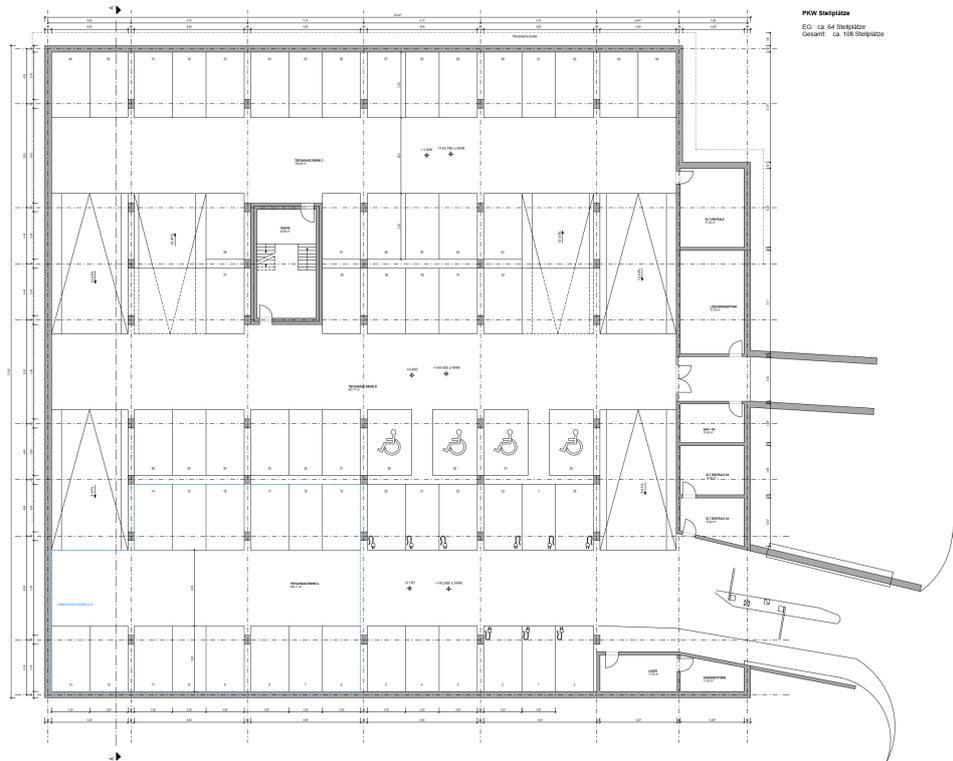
Grundriss der Tiefgarage [U 1.7]
